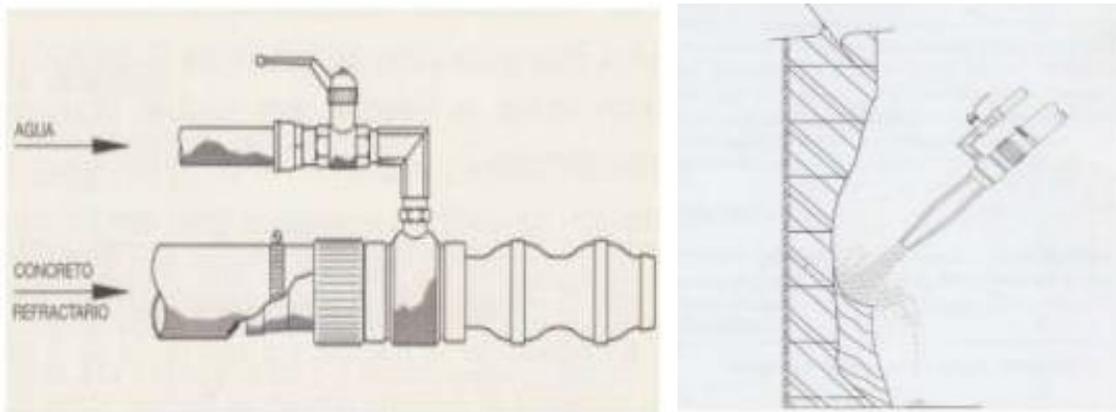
Posición de boquilla para lanzamiento de concreto. Fuente: Procedimiento de instalación de concreto refractario (2023)
